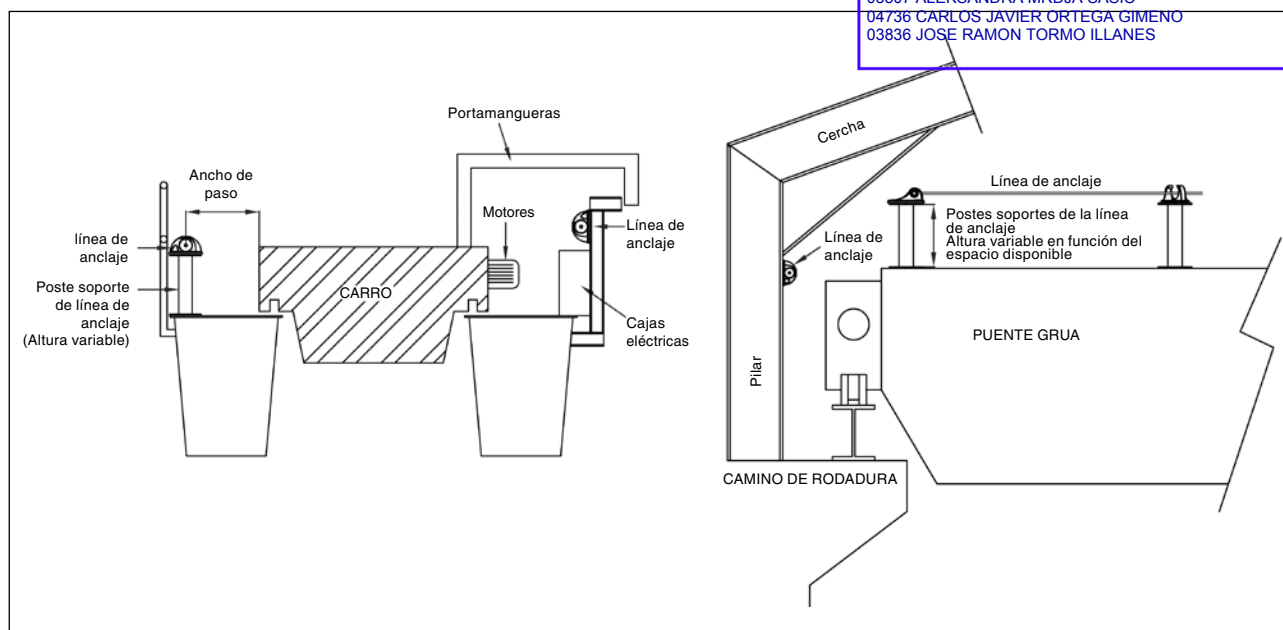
Esquemas de montaje de líneas de anclaje instaladas sobre un puente grúa
